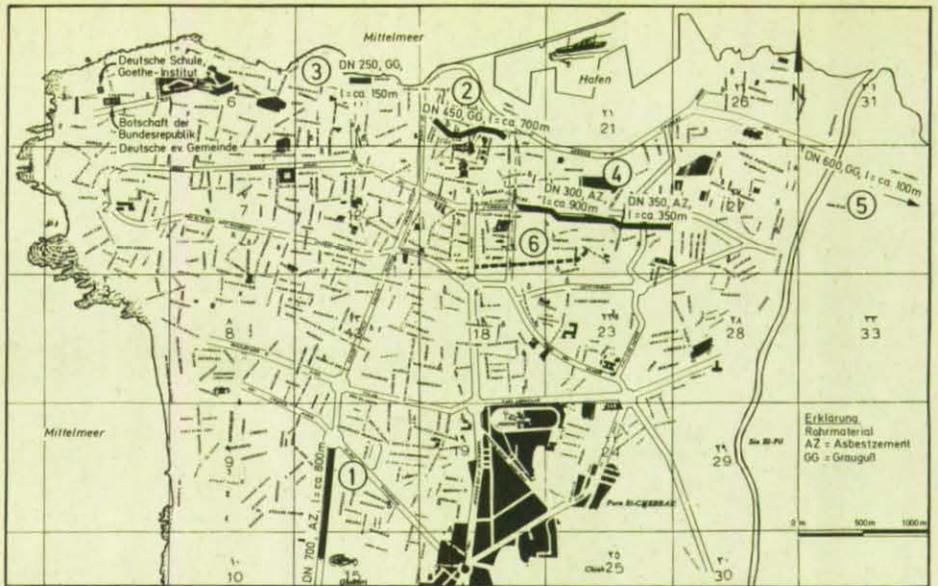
Ausschnitt aus dem Stadtplan von Beirut mit Darstellung der zu reparierenden Wasserrohrleitungen.
